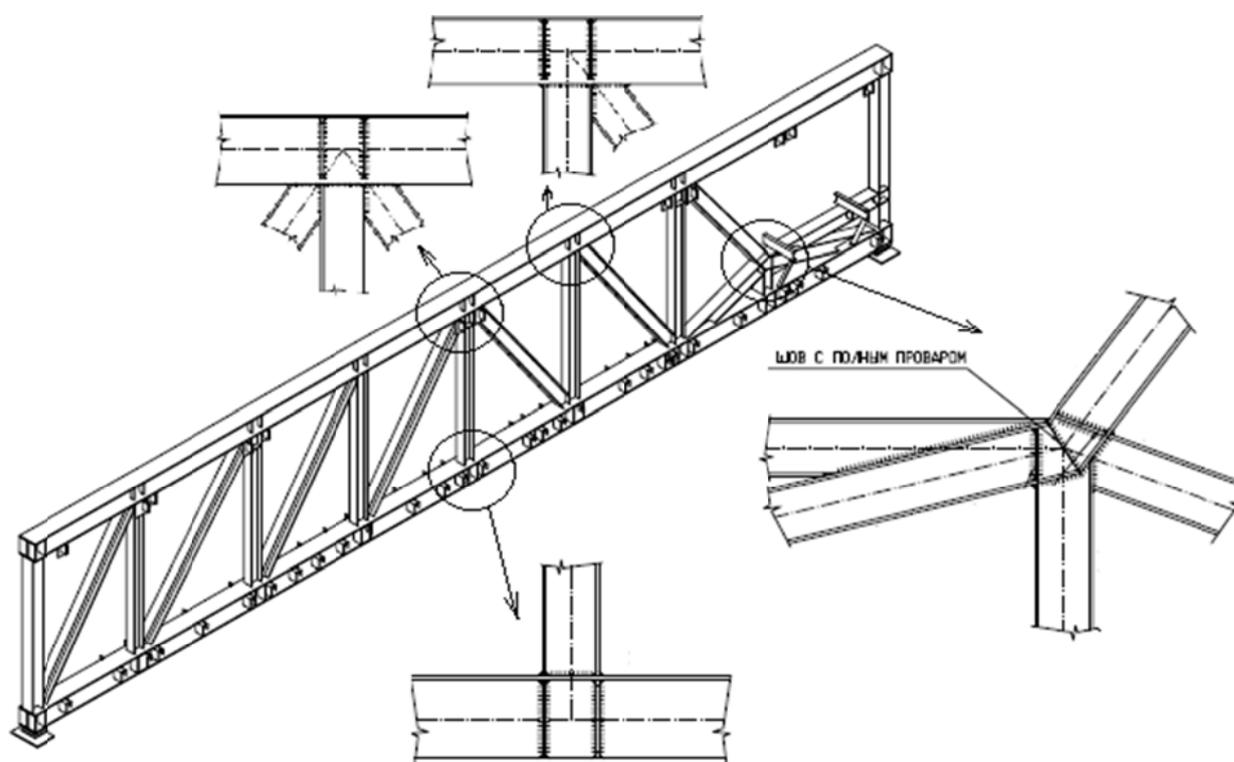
Ферма №3 театра имени Янки Купалы (с основными сварными узлами)
